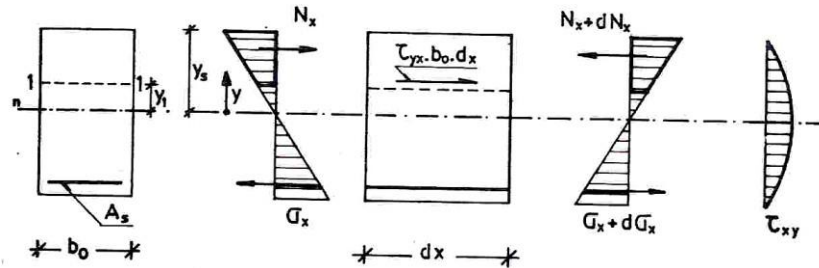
Flexión de elementos estructurales de hormigón armado.
